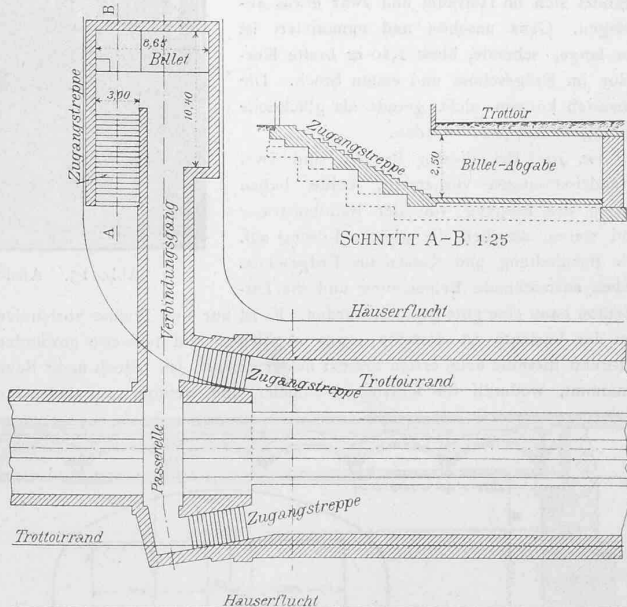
Typischer Grundriss einer Station. — 1:500.
